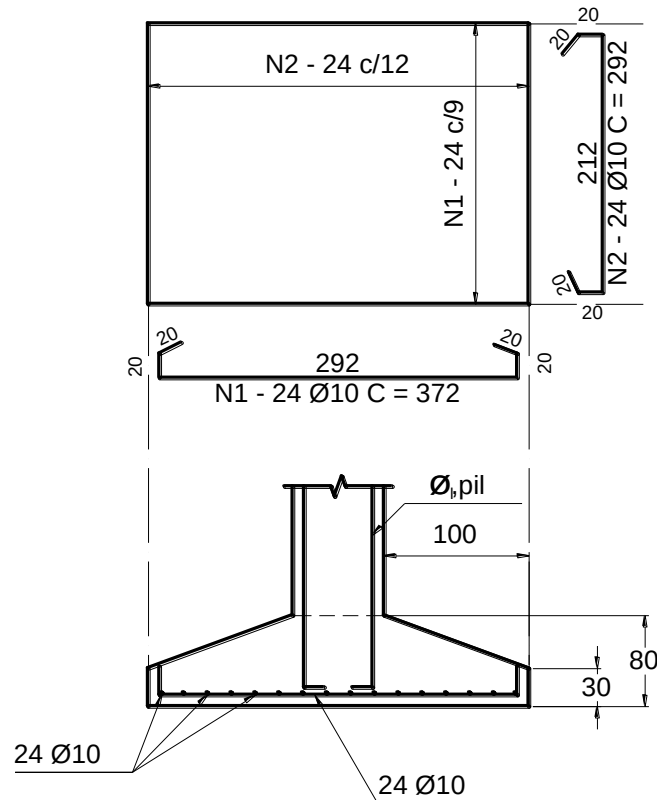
Detalhamento das armaduras de flexão da sapata.
